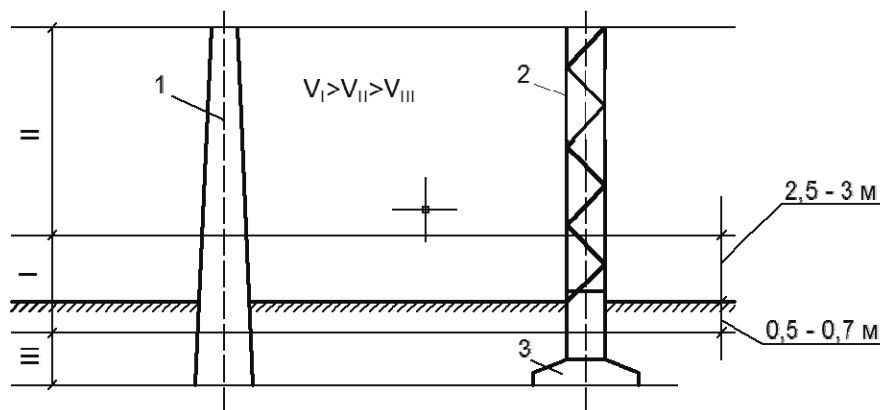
Зоны коррозии железобетонных конструкций ВЛ и подстанций: 1-железобетонная опора; 2-металлическая опора; 3-фундамент; I-сильная степень коррозии; II-средняя степень коррозии; III-слабая степень коррозии
